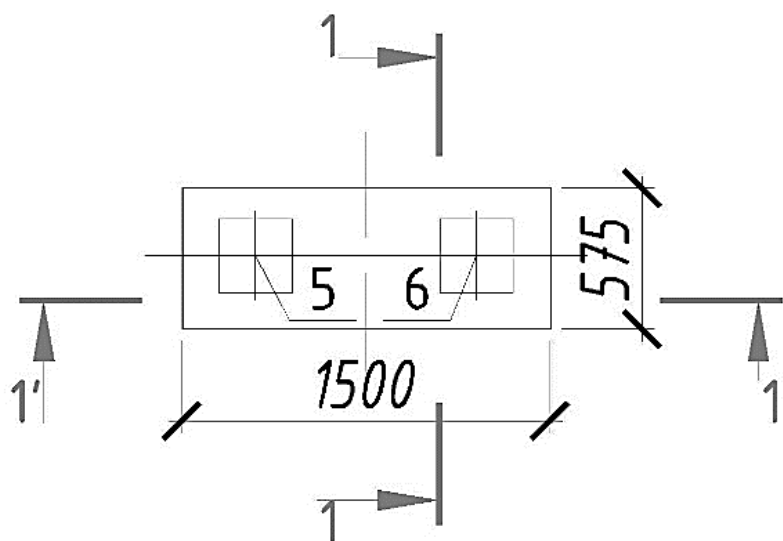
Схема к расчету арматуры плитной части фундамента
